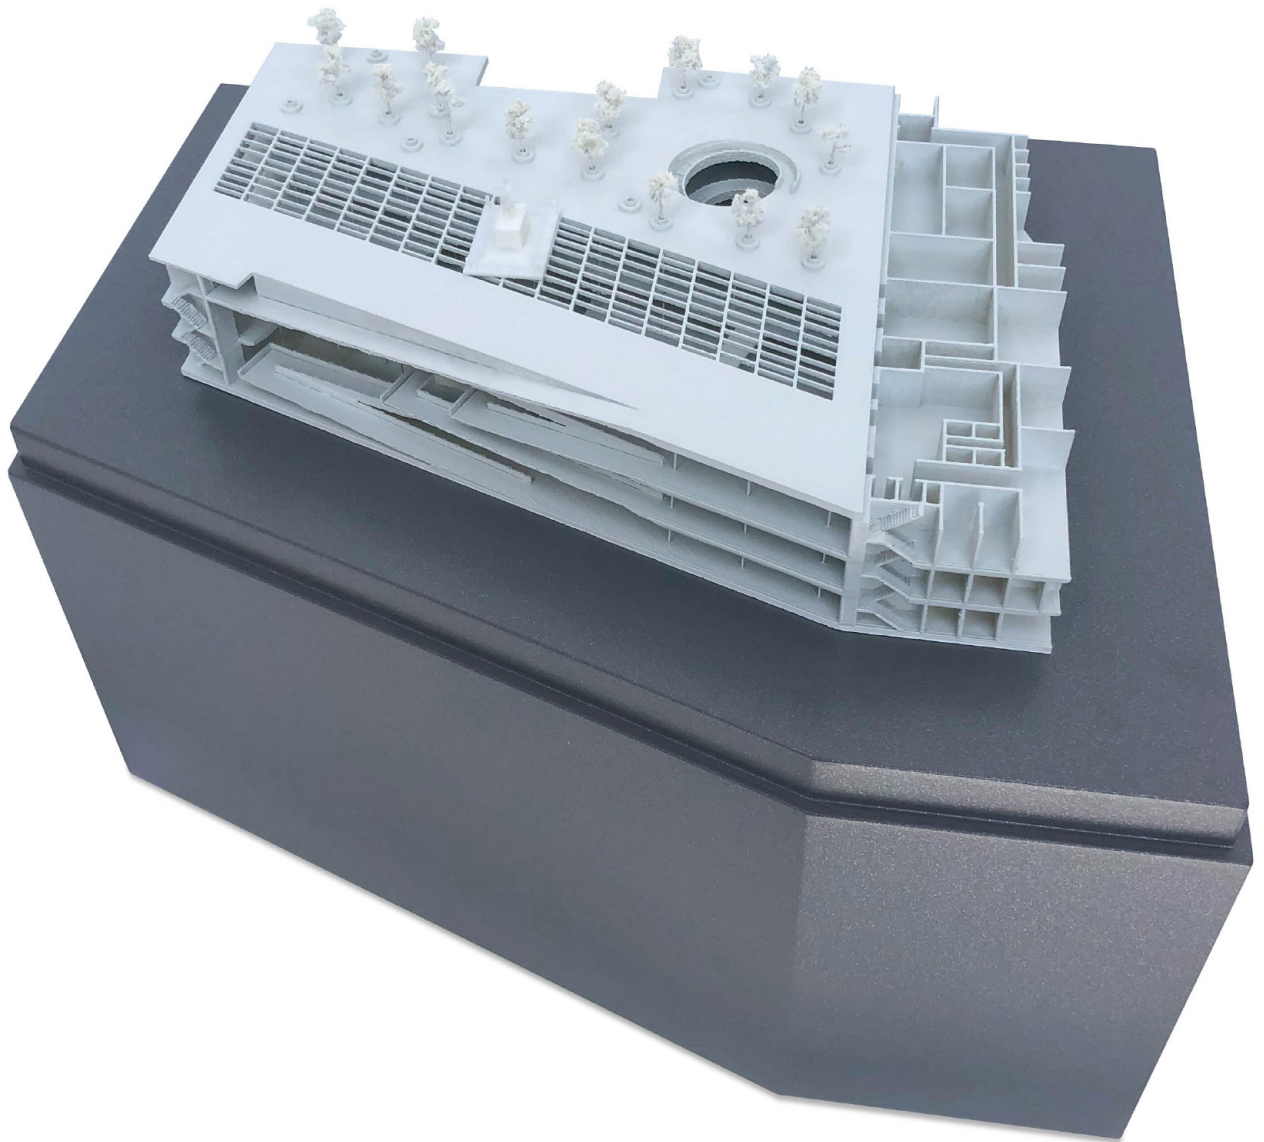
Modell ohne Dach / Erdgeschoßzone
